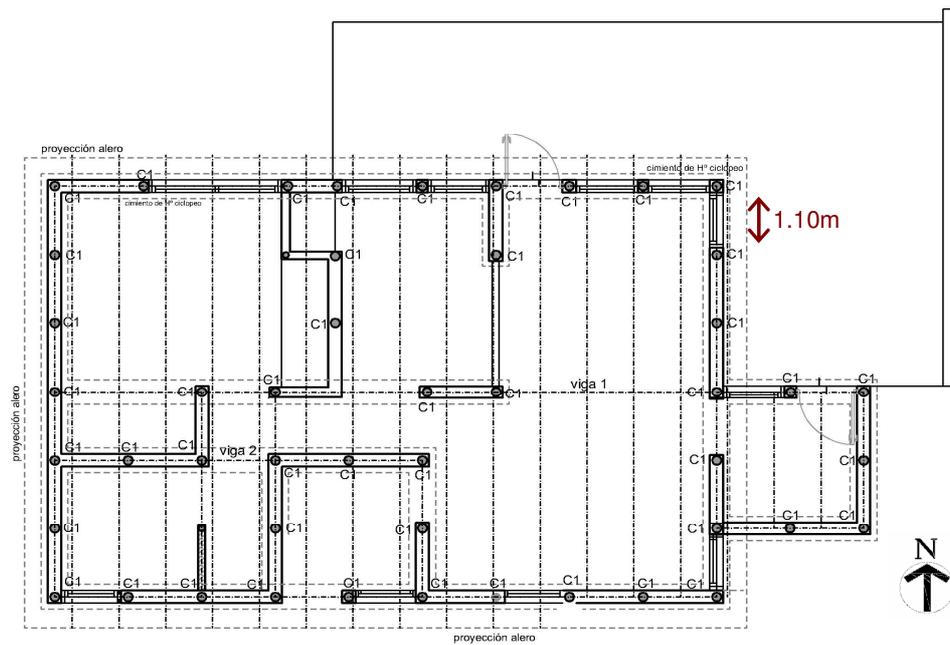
Planta estructural del proyecto. Se observa la colocación de columnas cada 1.10 m, marcando la modulación del sistema constructivo
